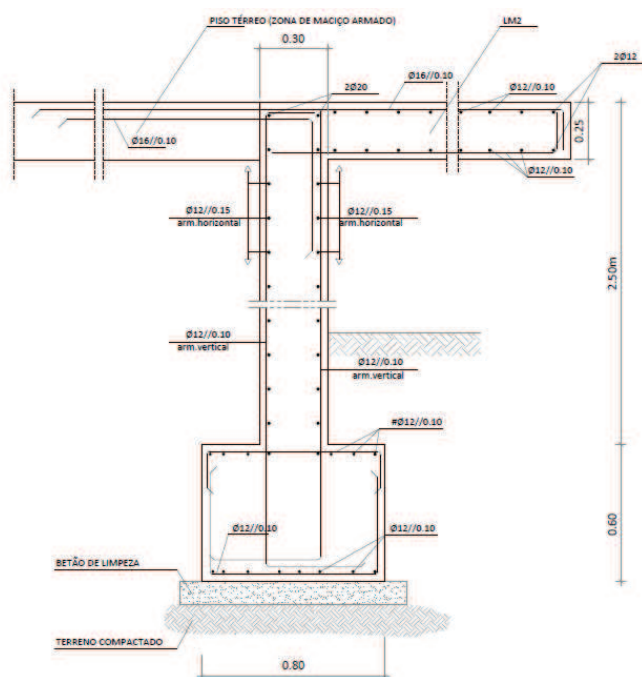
Corte de representação da viga lintel, muro de suporte e laje em consola com o respetivo contrabalanço.
